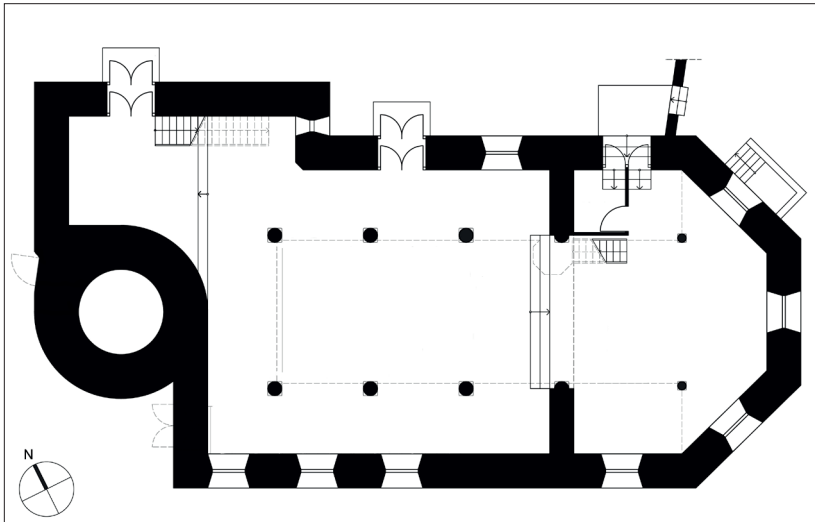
Grundriss in Fußbodenhöhe.
